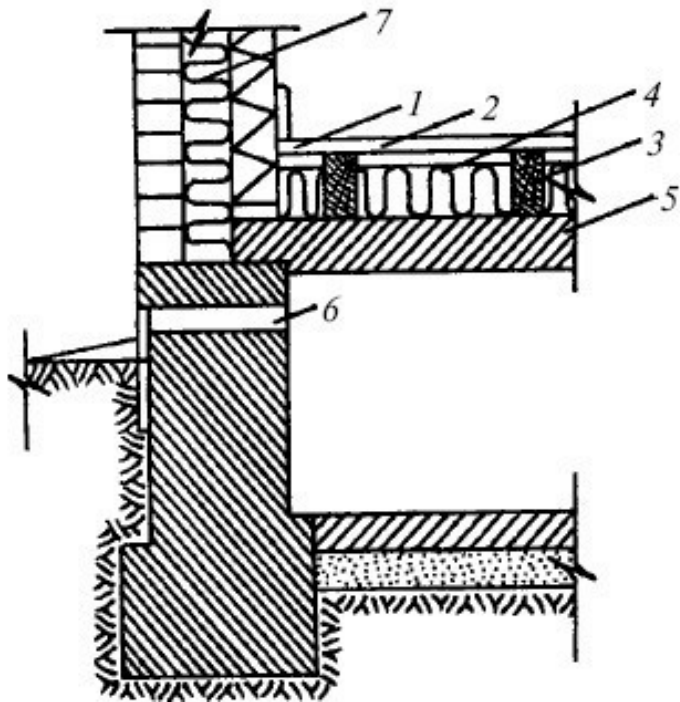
Утепление пола, уложенного на бетонное перекрытие: 1 – пол; 2 – пароизоляция; 3 – лага; 4 – теплоизоляция; 5 – плита перекрытия; 6 – вентиляционный продух; 7 – теплоизоляция стены
